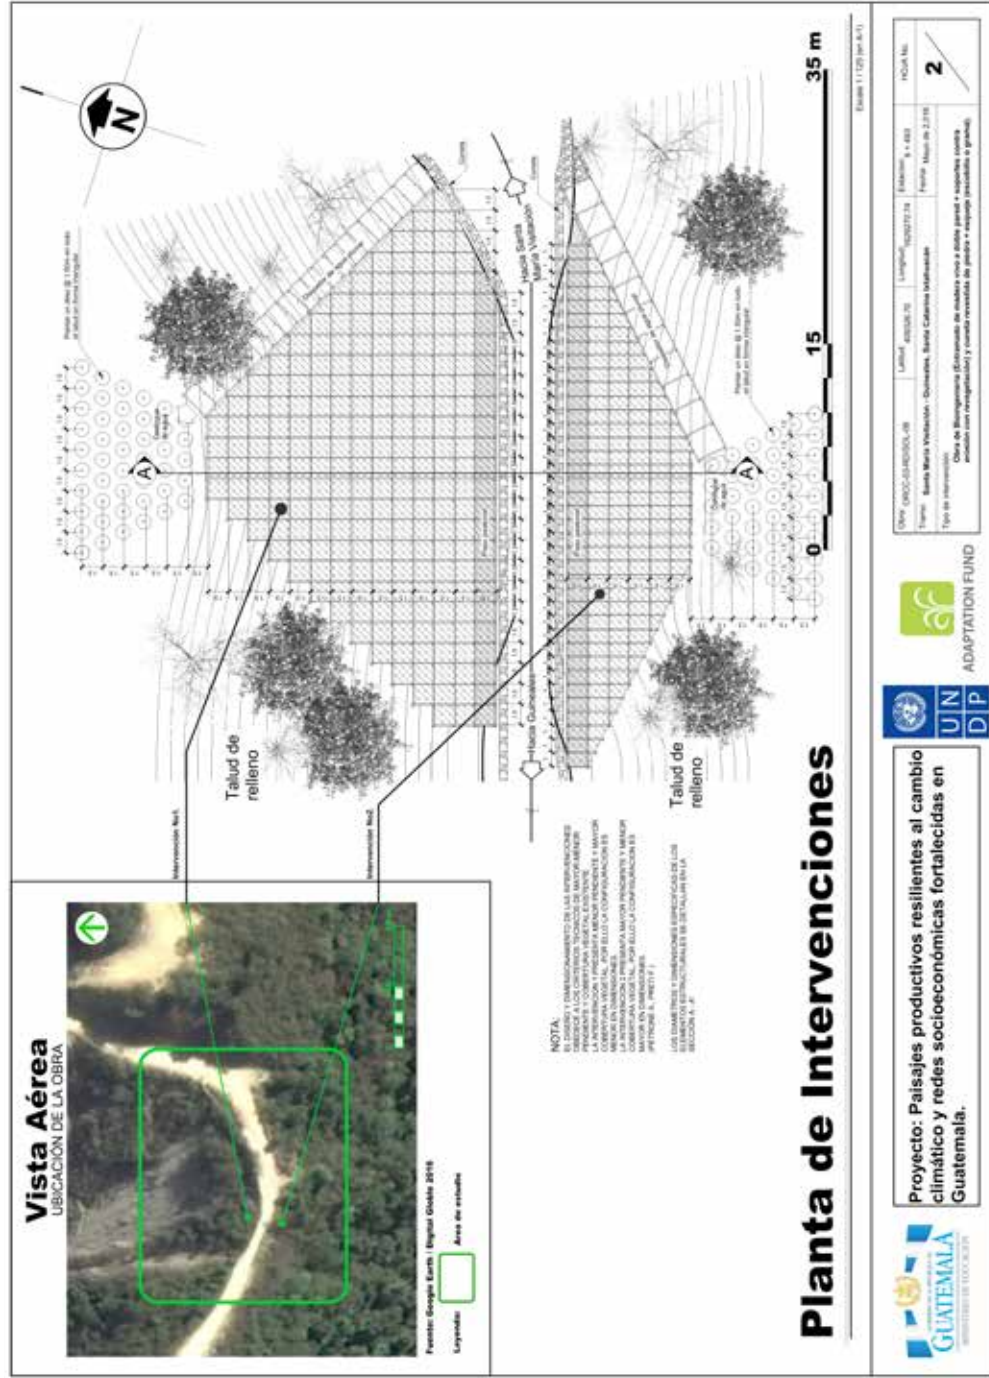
A. PLANTA DE INTERVENCIÓN. Planificación Obra ORCC-03/RD-SOL-08. Tramo: (Santa María Visitación-Guineales, Sta. Catarina Ixtahuacán)
